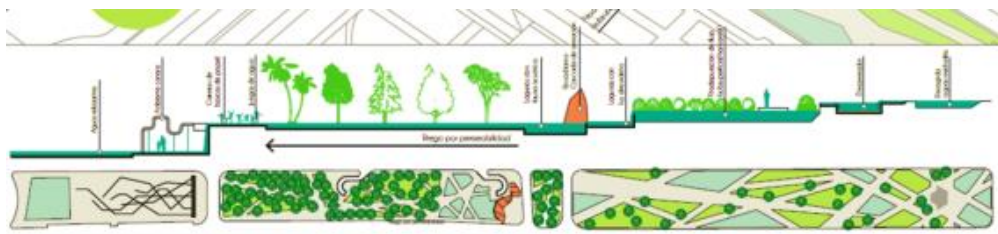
Sección y planta propuestas para el boulevard biodigestor CO³
